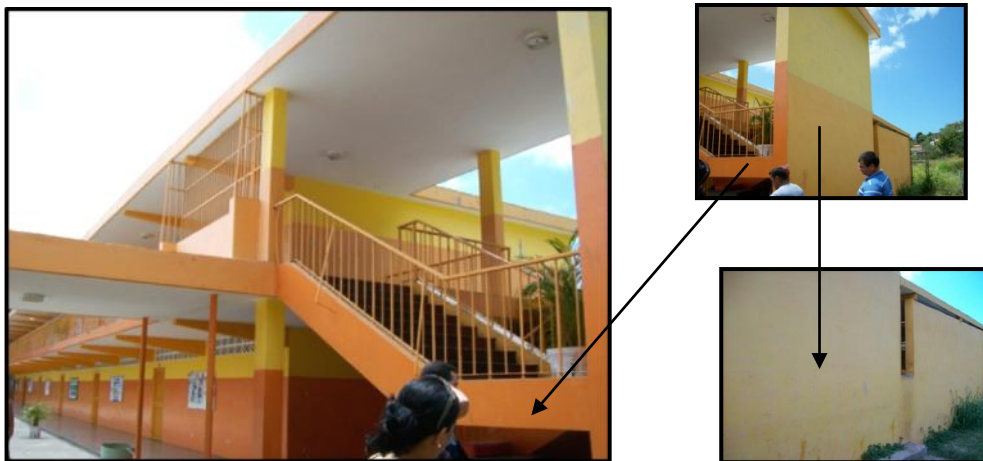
Módulo de la escalera. (Fachada Este del módulo II)
